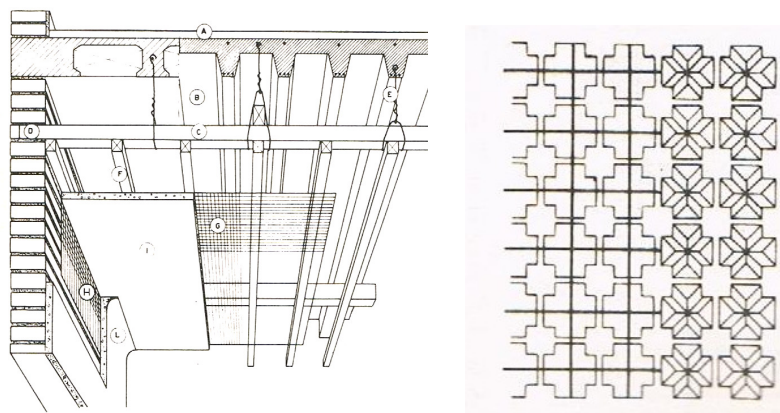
Particolare costruttivo di un controsoffitto di tipo Stauss e dettaglio del reticolo metallico su cui sono attaccate le crocette di laterizio. (fonte Manuale dell'architetto)
